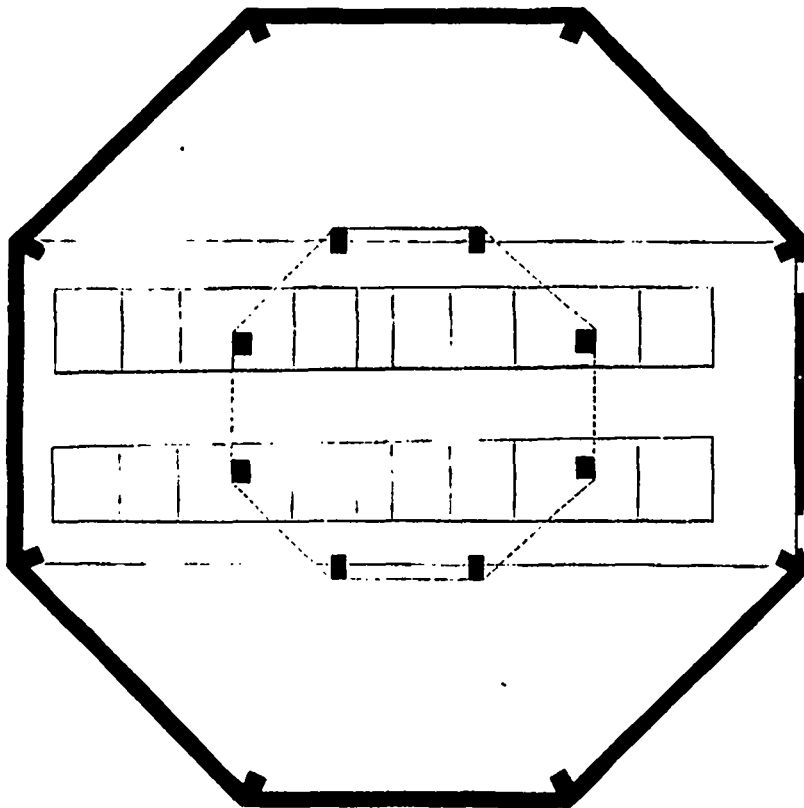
FIG. II—VUE EN PLAN, A LA HAUTEUR DE L'ÉTABLE.
